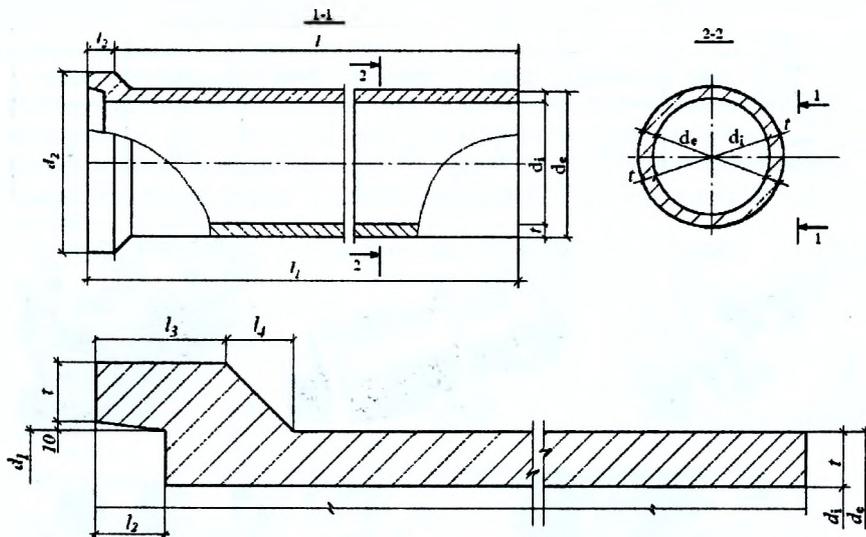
Общий вид труб железобетонных цилиндрических раструбных типа Т по ГОСТ6482-88
